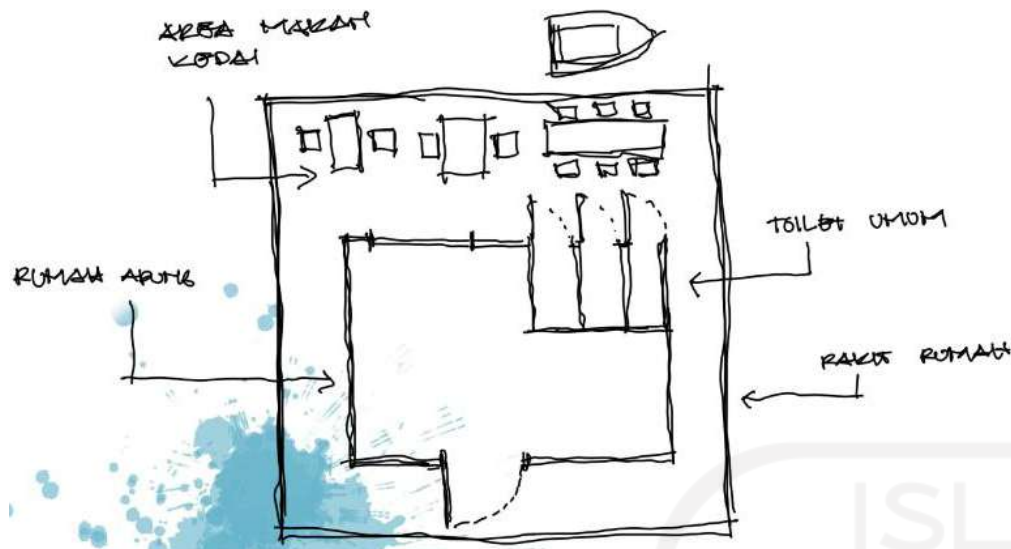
Ilustrasi Denah Kedai Rumah Apung
